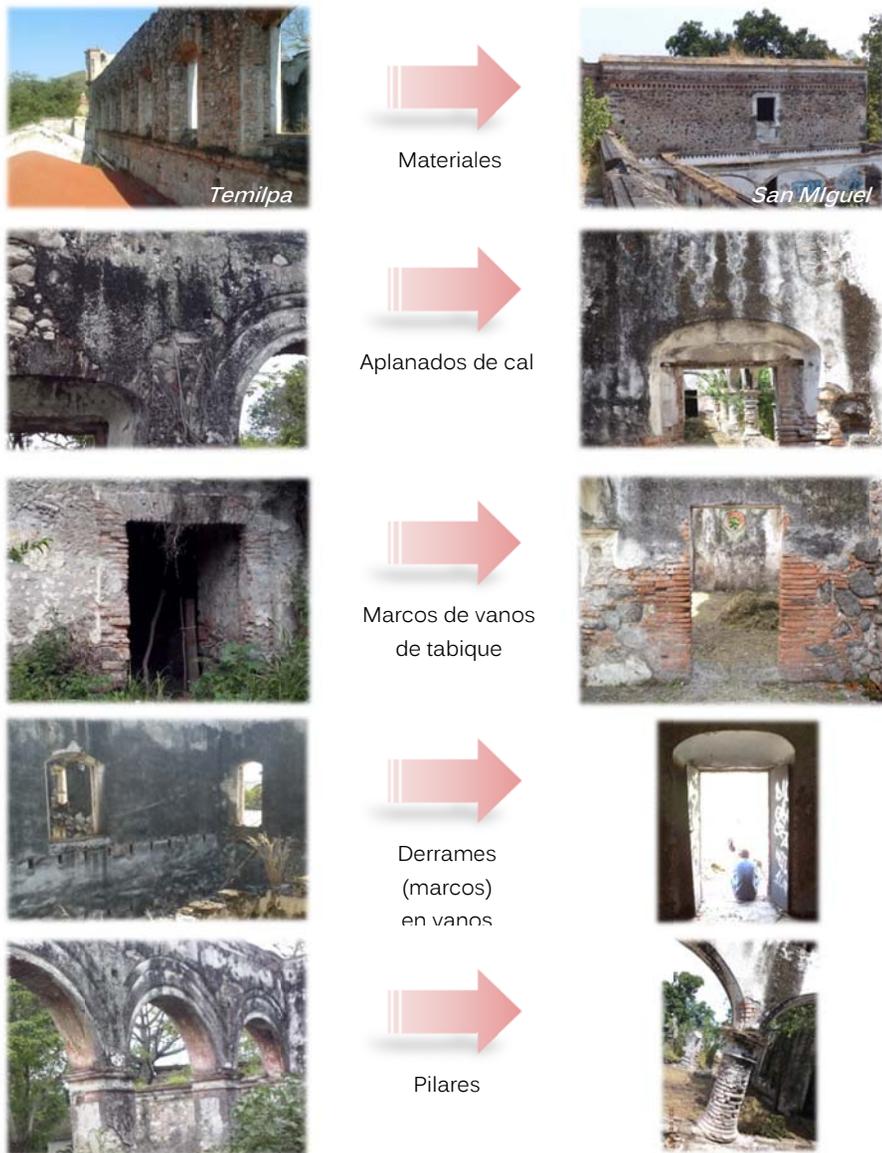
Similitud en detalles constructivos entre las haciendas Temilpa y San Miguel Treinta.
